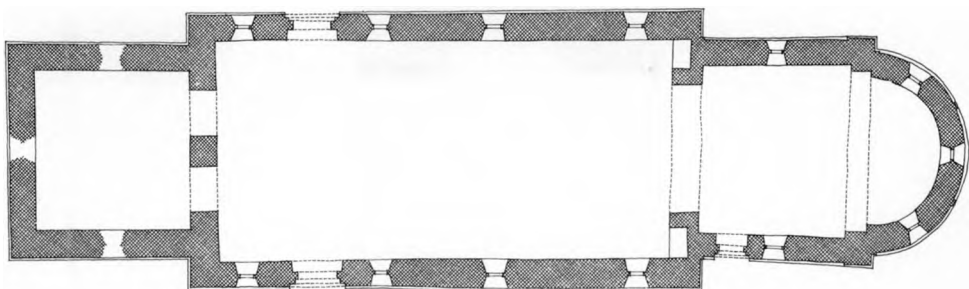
Broager. Rekonstruktion af kirkens oprindelige plan, herunder det projekterede tårn (sml. fig 4).
